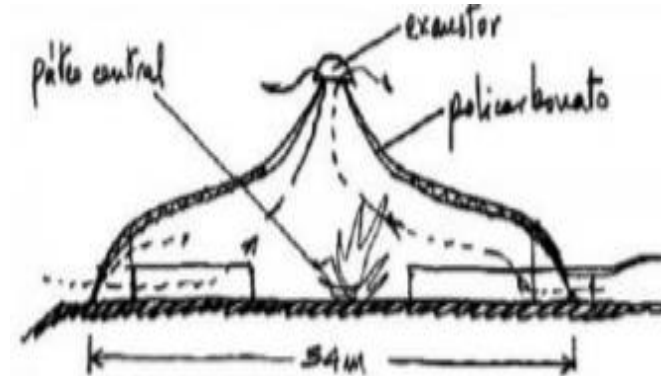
Corte esquemático do sistema de ventilação do centro de apoio
